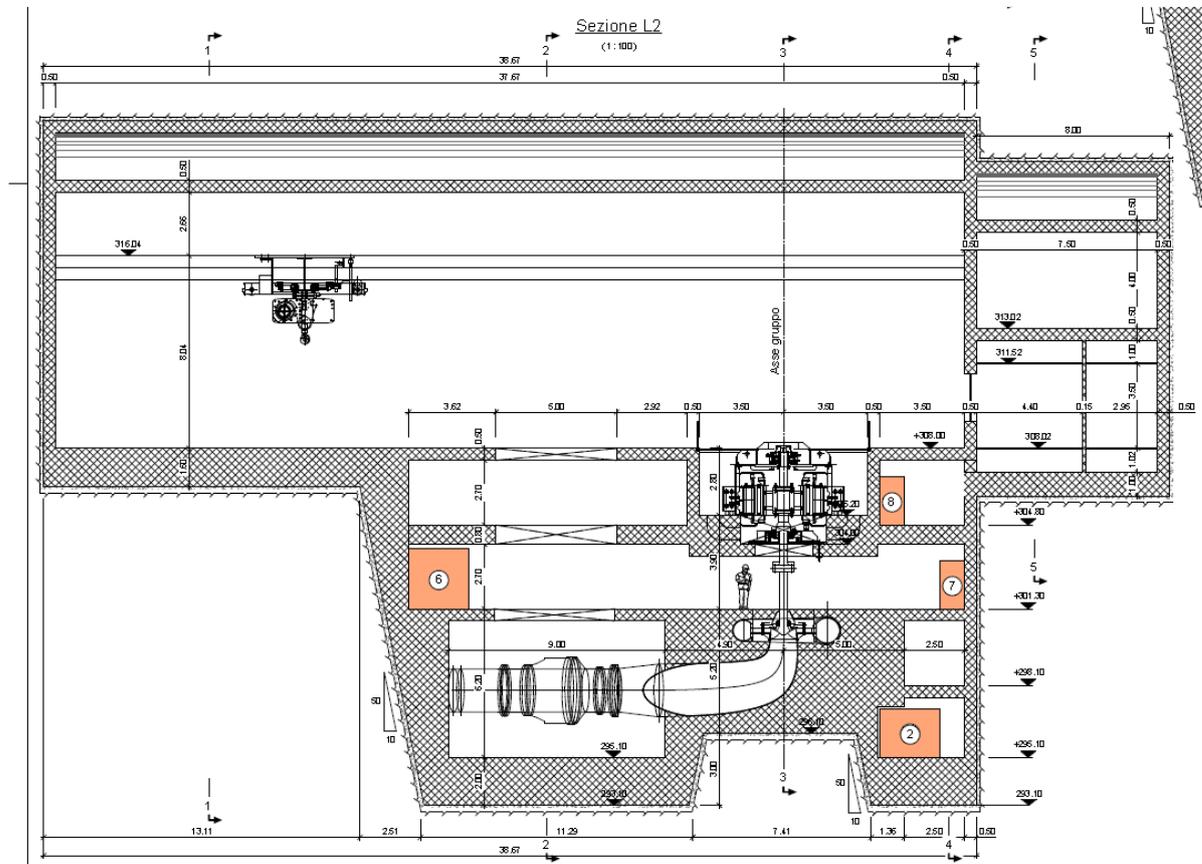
Centrale di Valcimarra II - sezione longitudinale
